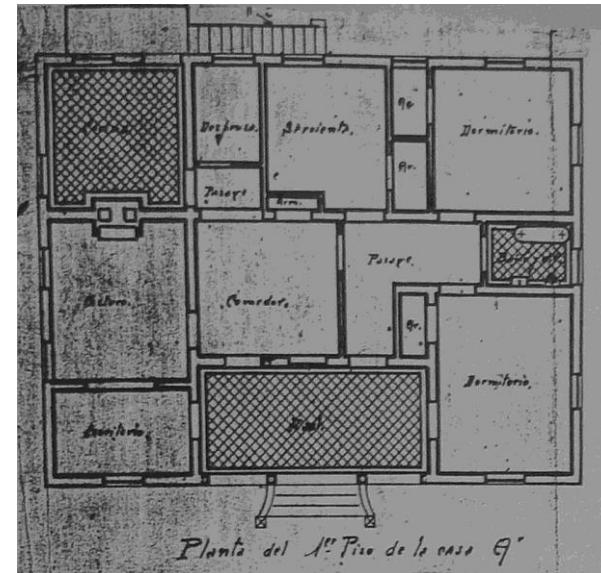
Planta do primeiro piso da Casa "A". Arq. John Adams, maio de 1917. Fonte: BRAGHIROLI, 2014, p.273.
